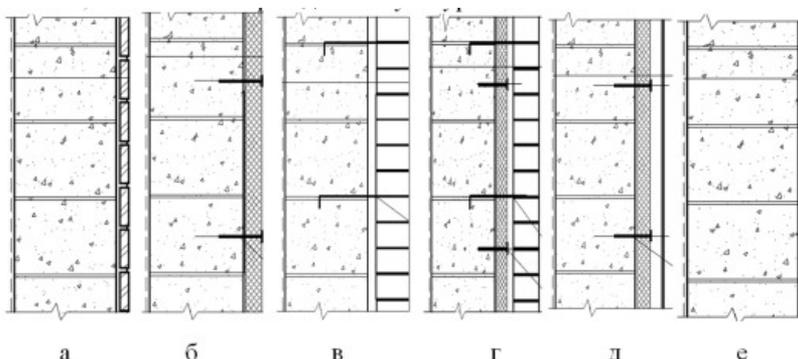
Конструктивные решения и системы отделки стен из автоклавного газобетона а) облицована плиткой керамической; б) с тонкослойной системой утепления в) облицована кирпичом с вентилируемым воздушным зазором г) облицованная кирпичом с дополнительной теплоизоляцией д) с «навесным вентилируемым фасадом» е) – однослойная стена отделанная штукатуркой
